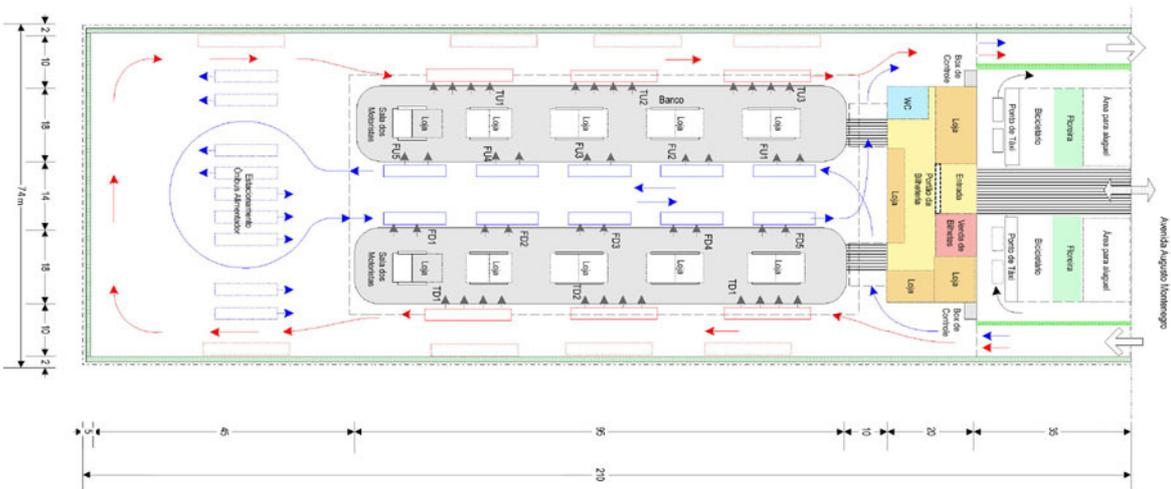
Localização e Planta do Terminal B: Tapanã (sem escala)
